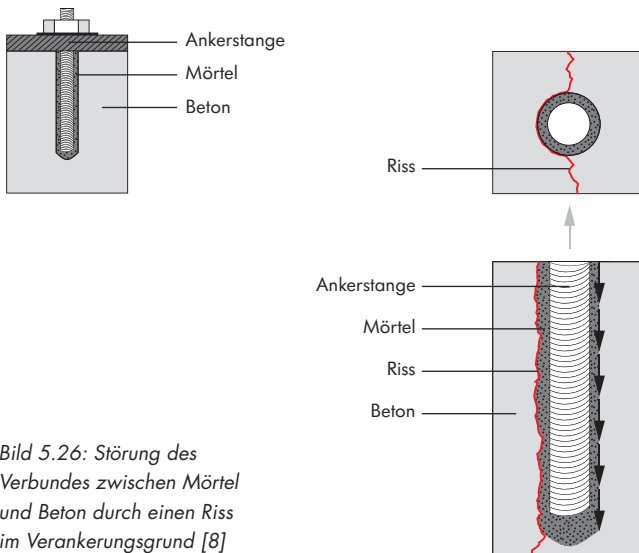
Störung des Verbundes zwischen Mörtel und Beton durch einen Riss im Verankerungsgrund [8]
